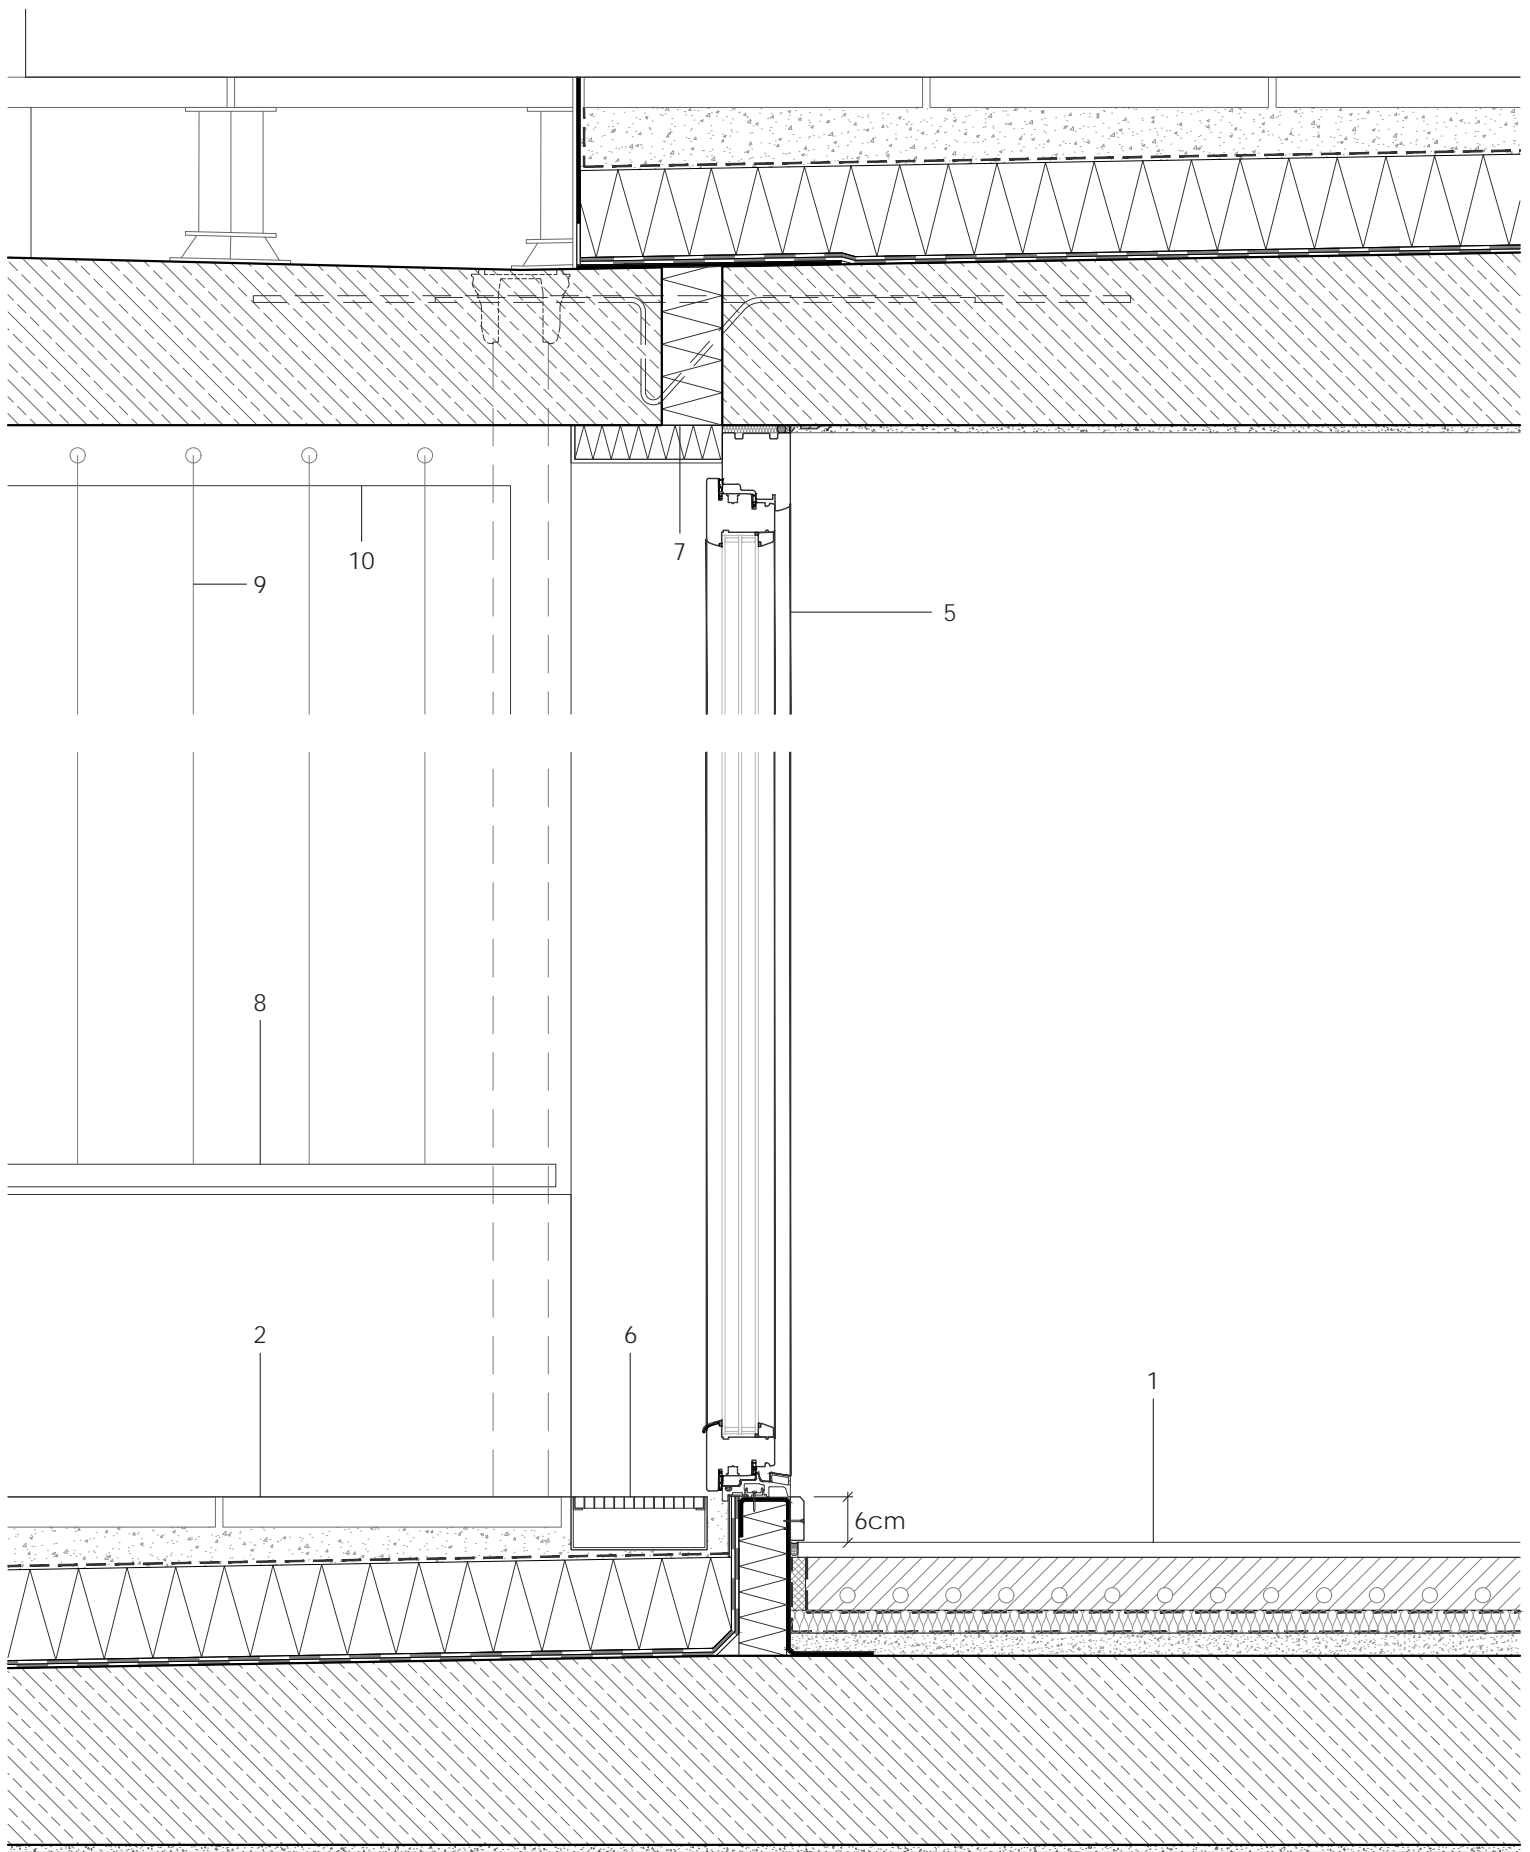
Fassadenschnitt Terrassen M 1:10.
